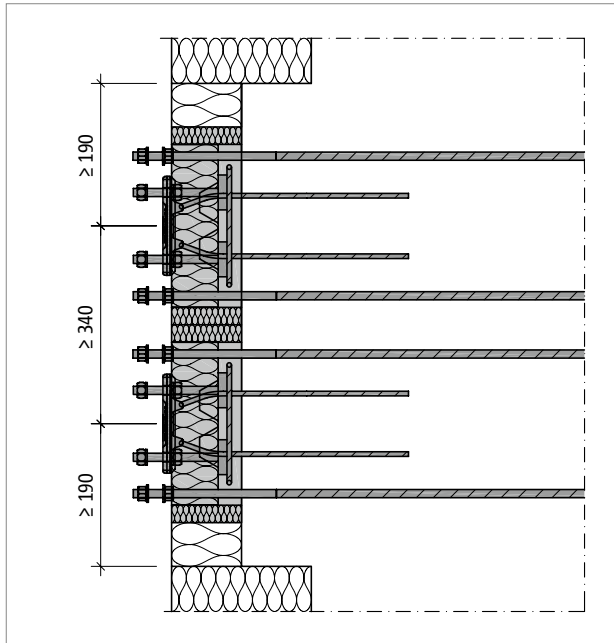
Schöck Isokorb® RT Typ SK: Rand- und Achsabstände
